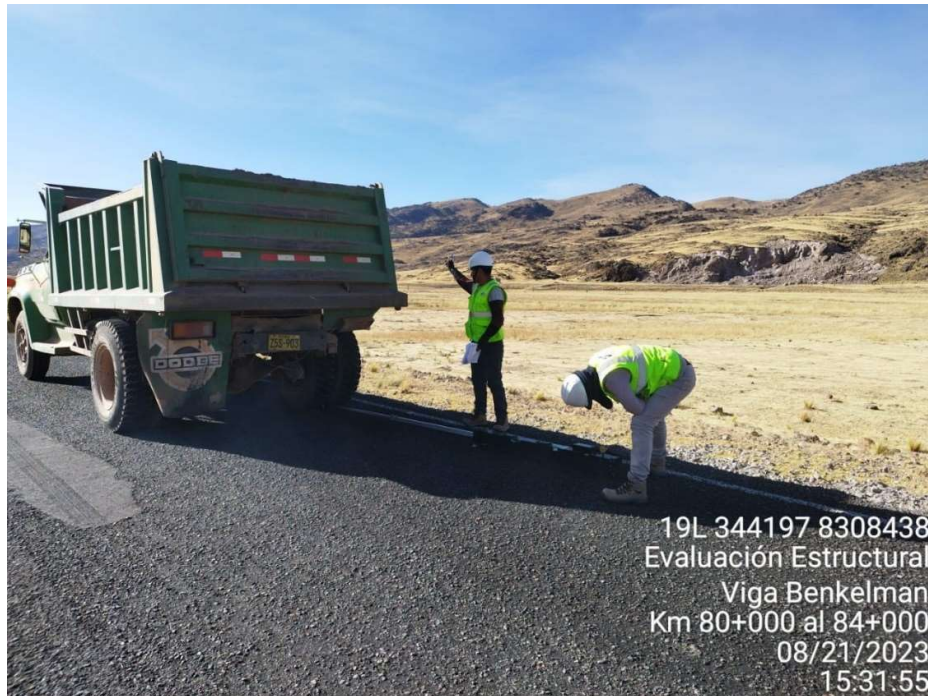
Equipo de trabajo en campo para ensayo de Viga Benkelman.
